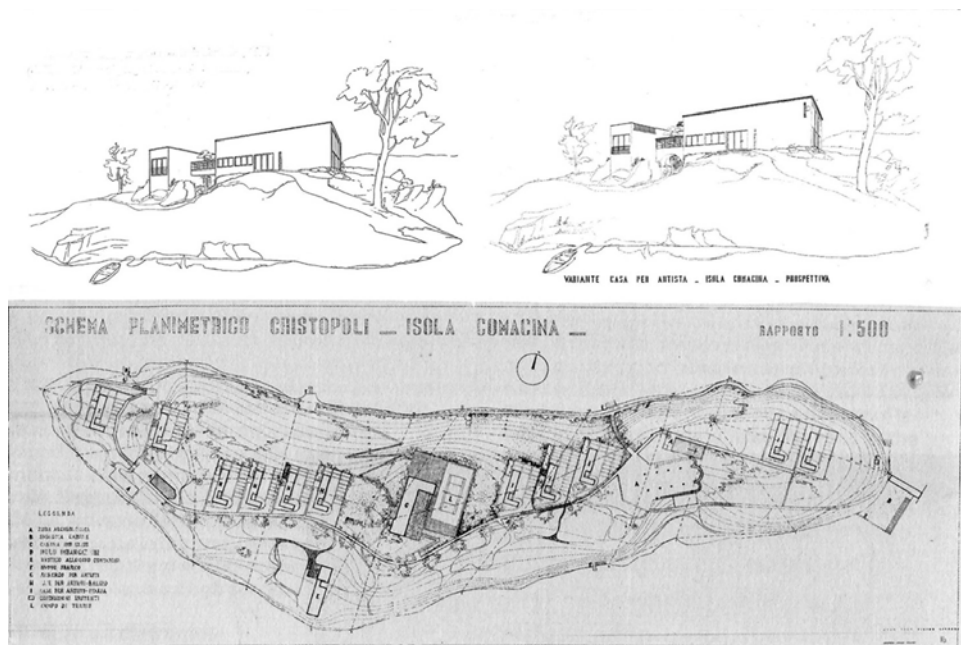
Planimetria del progetto Cristopoli (1933) e viste prospettive di due varianti della villa-atelier tipo. Archivio Lingeri.
